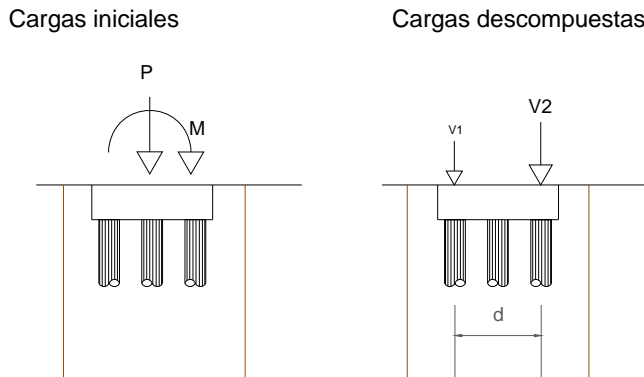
Cargas iniciales grupo de tres pilotes y cargas descompuestas para cálculo.
